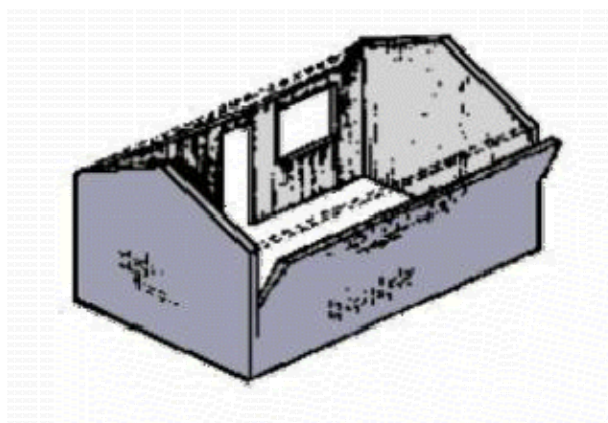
Desprendimiento de muro por falta de amarre en los "bordes" verticales y horizontales
